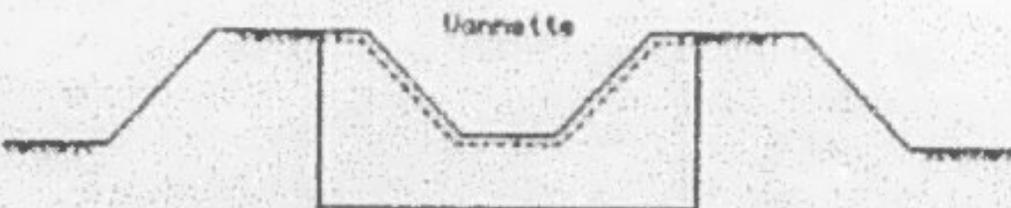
Dispositions constructives pour un canal en terre revêtu de béton
